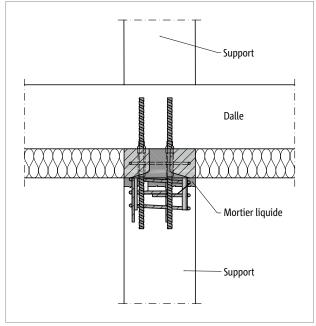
Schöck Sconnex® type P : raccordement d'un poteau interne à la dalle sus-jacente
